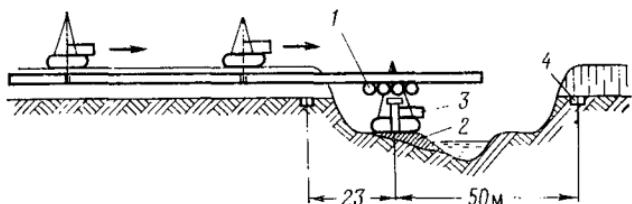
Схема монтажа перехода с использованием вместо временной опоры трубоукладчика с подвешенной к его крюку тrolleyной подвеской:
